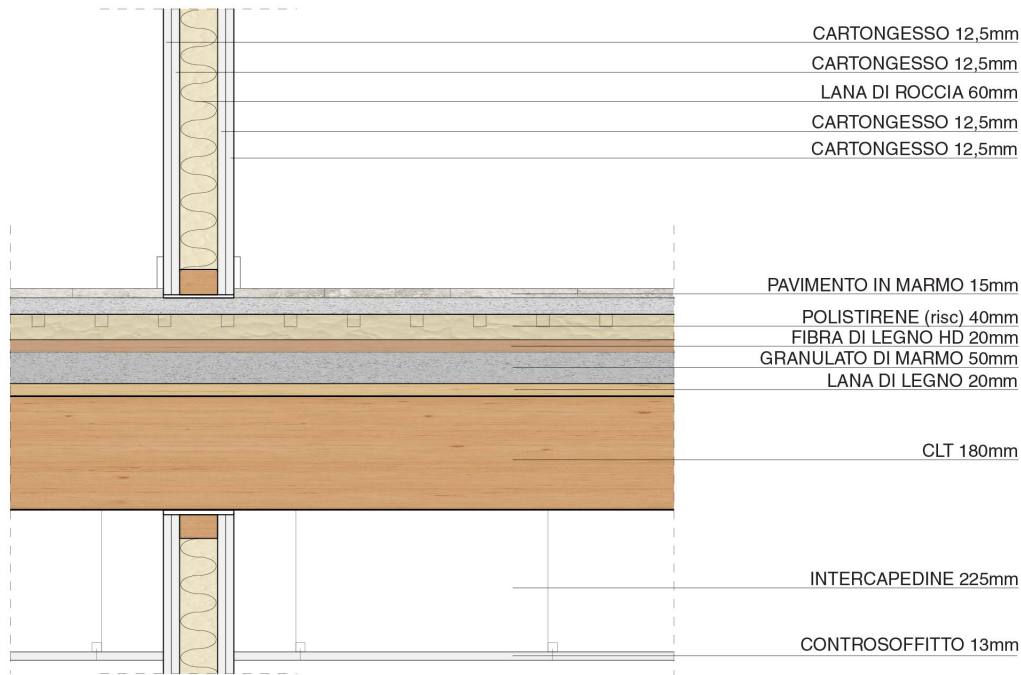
Dettaglio tridimensionale della parete interna con il solaio
